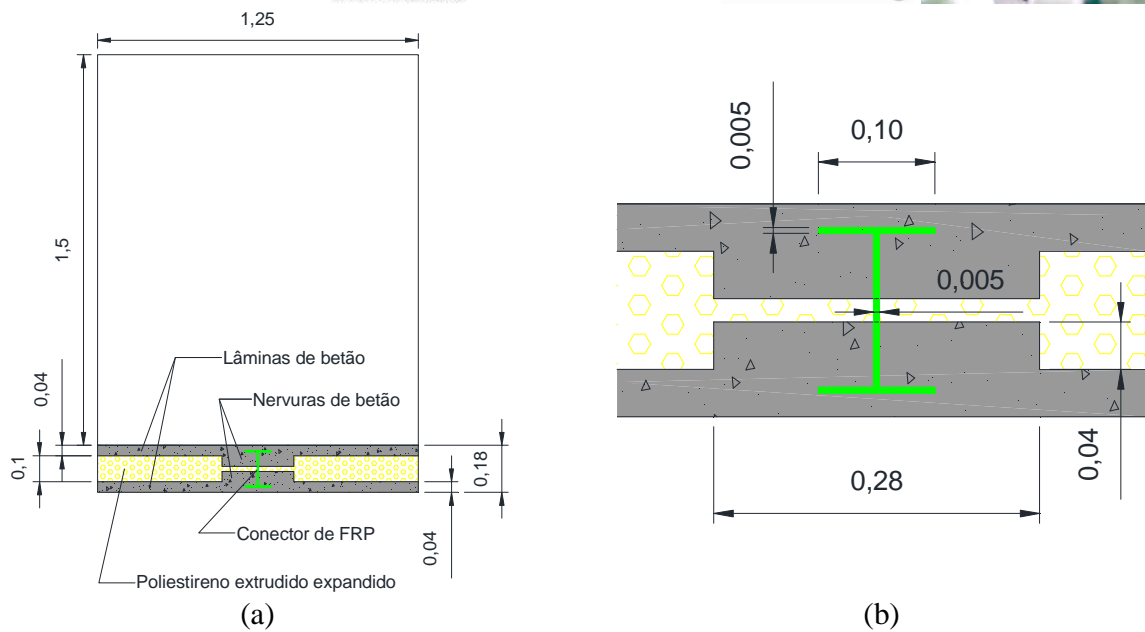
Geometria do painel sandwich com conectores perfil I de FRP embebido em nervuras (vista em planta e pormenor; unidades em metros).
